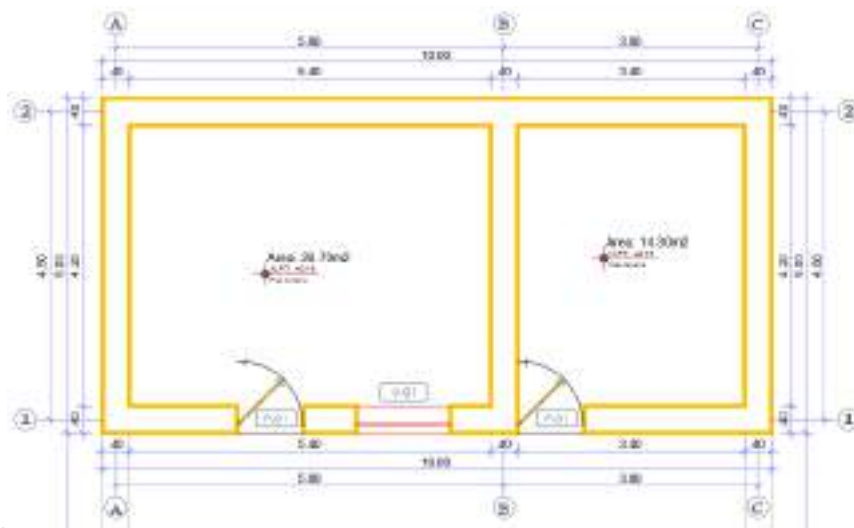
Distribución en planta de la vivienda rectangular mediana.
